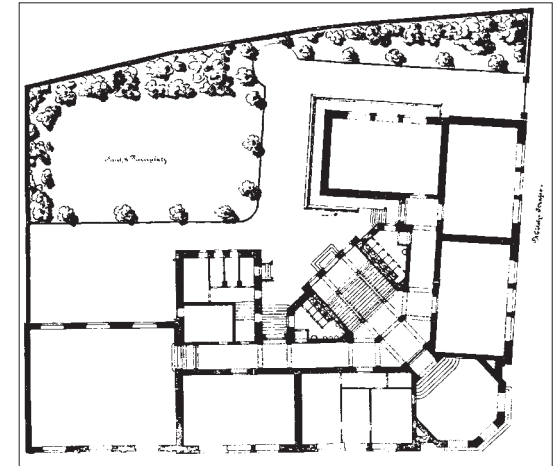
Grundriss der Erweiterungsbauten (1891)
